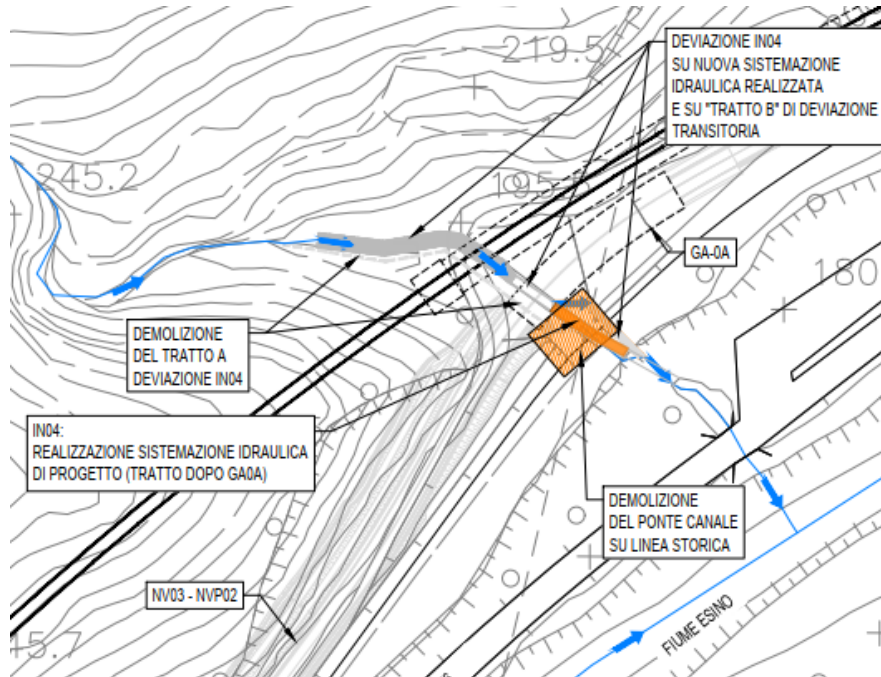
Schema fase 3: nuova sistemazione idraulica in esercizio con deviazione temporanea per demolizione ponte canale su linea storica
